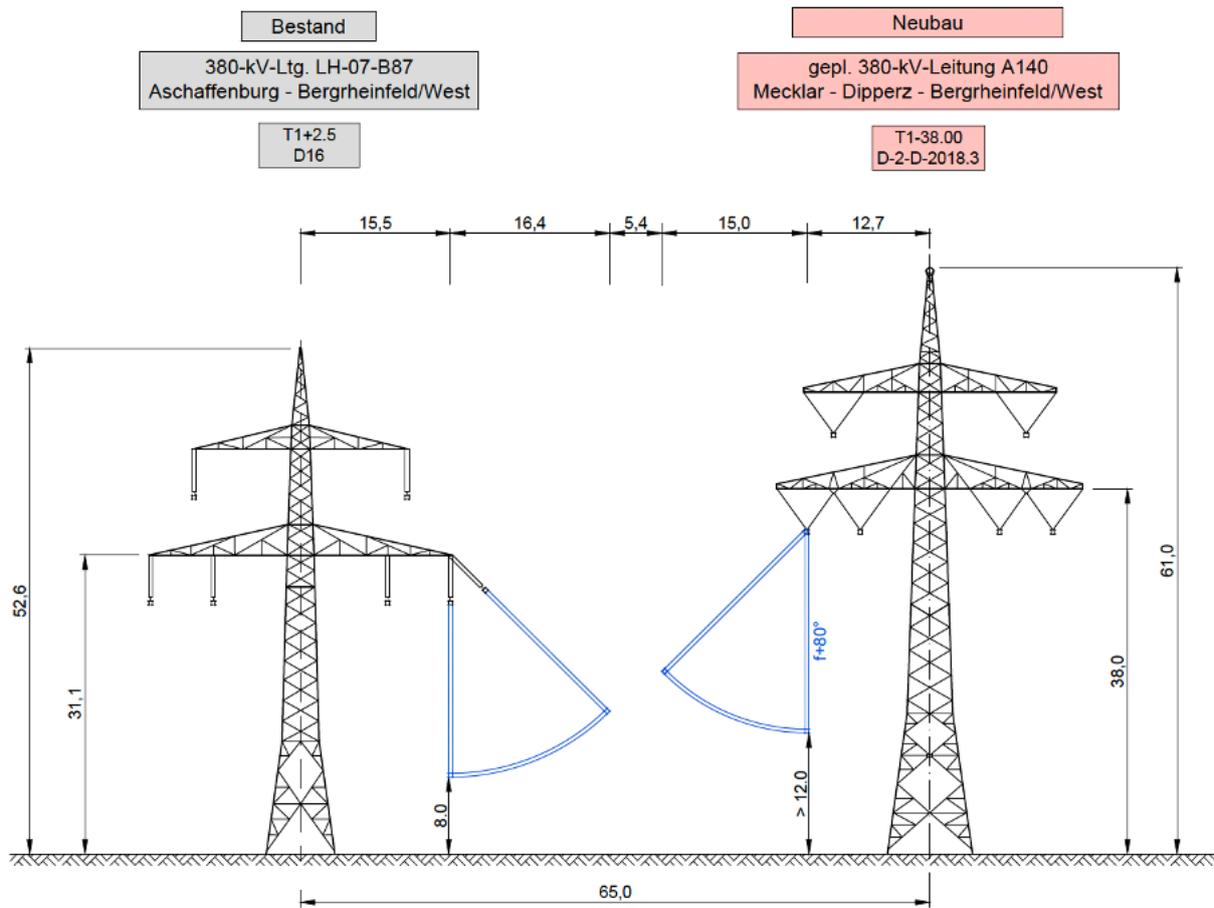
Parallelführung einer 380-kV-Neubautrasse neben der 380-kV-Bestandstrasse (alle Maße in m)
